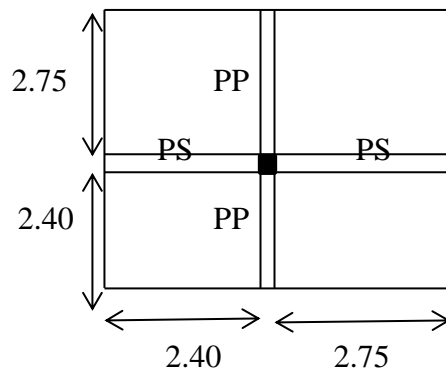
Surface afférente du poteau le plus sollicité.
